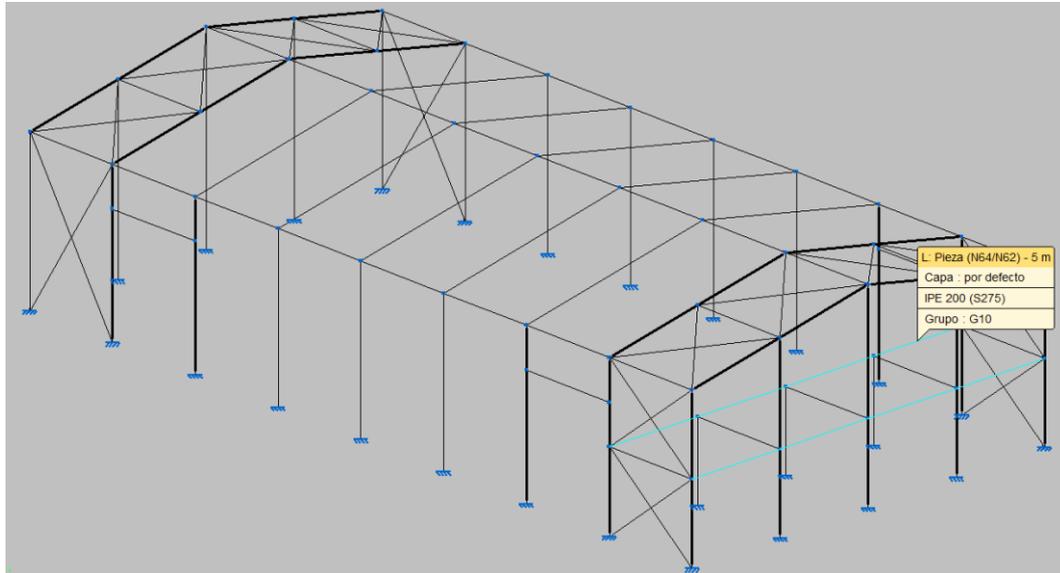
10 Grupo 10 de perfiles. Fuente: [CYPE 3D, 2019]
